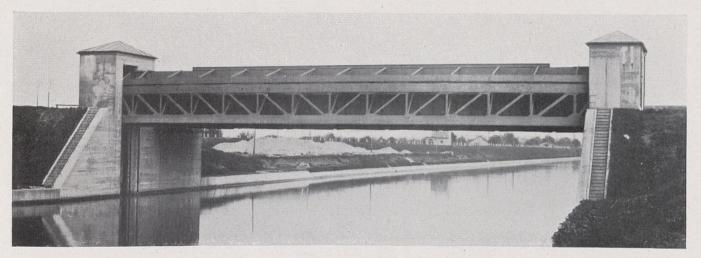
Staustufe Ladenburg. Hochwasserabschluß mit Straßenbrücke im Seitenkanal.
